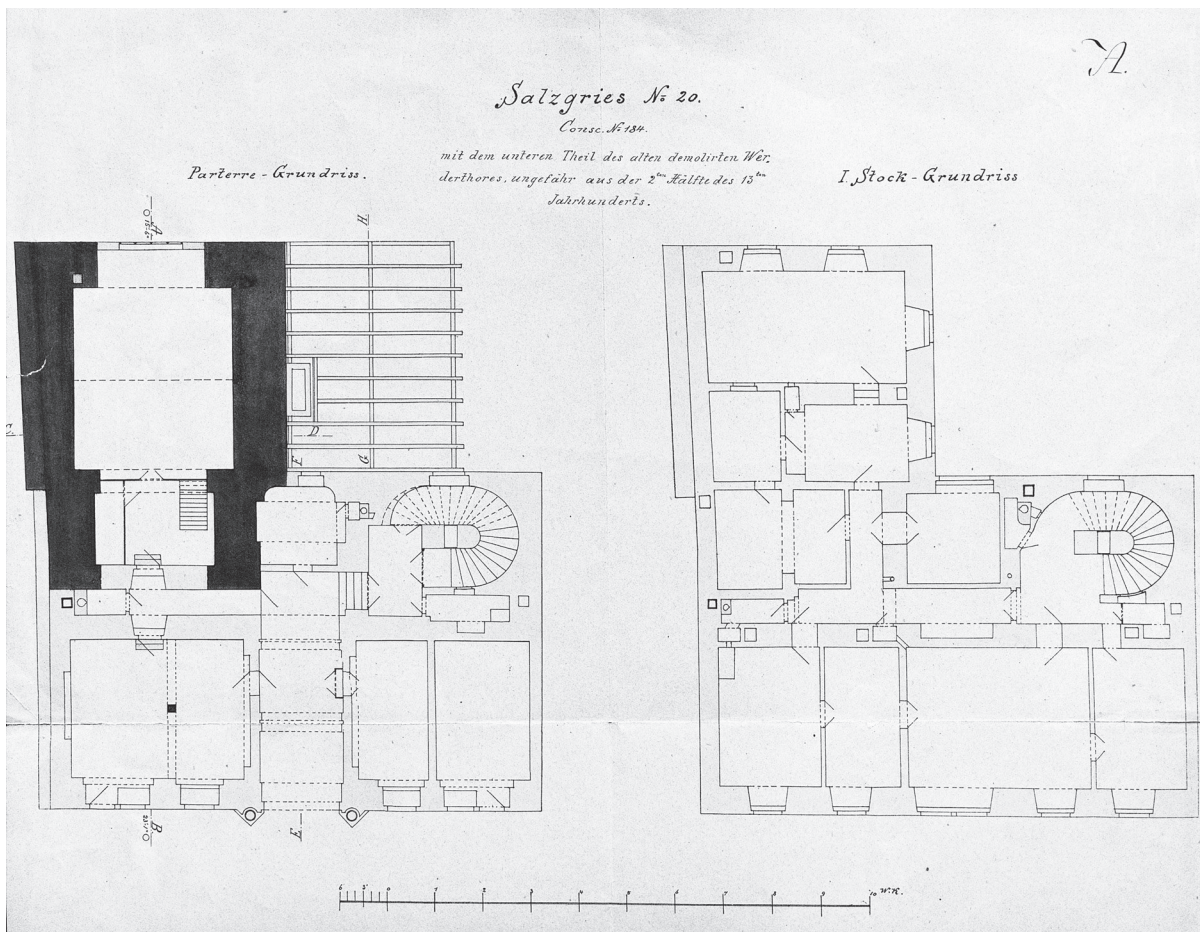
Grundrissplan des Werdertors um 1880? (WStLA, KS, Sammelbestand P 1 – Pläne und Karten 214/Plan 1).
